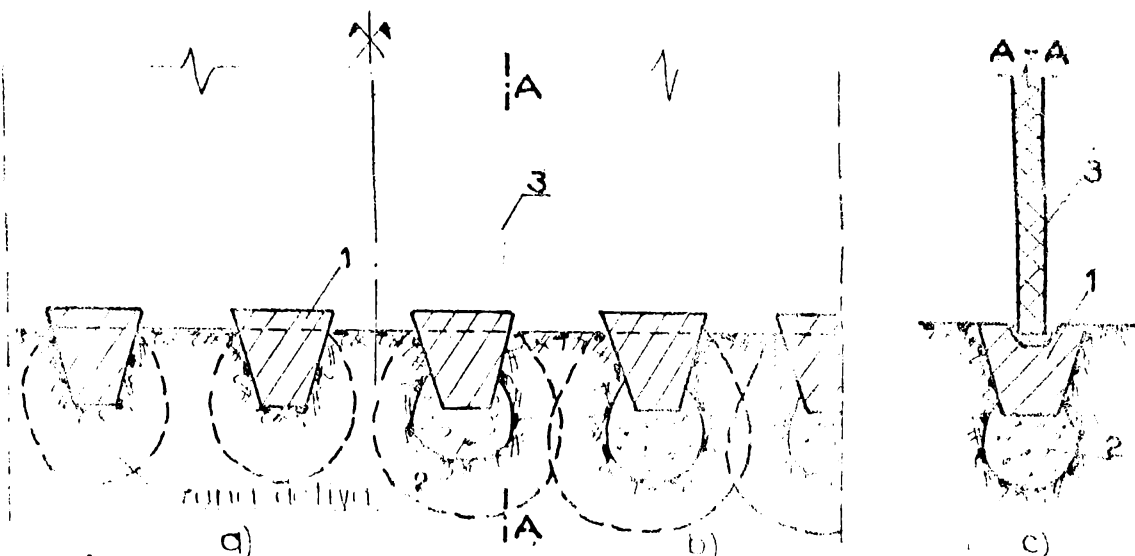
Fundaţii cu tălpi discontinue: a) elemente discontinue fără bulb; b) elemente discontinue cu bulb; c) secţiune verticală prin fundaţie: 1) element prefabricat sau monolit; 2) bulb din material granular; 3) elevaţie prefabricată.
